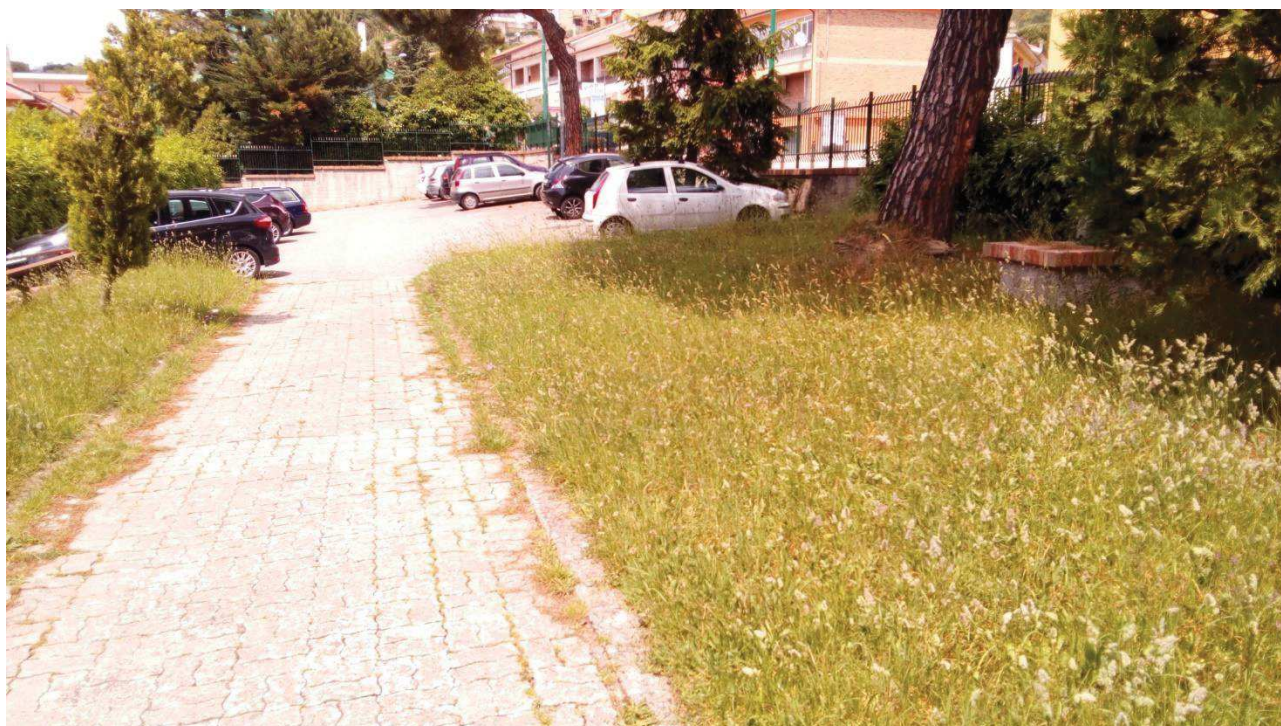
[Plesso Mancini] Situazione del verde sulla facciata principale ante operam.
